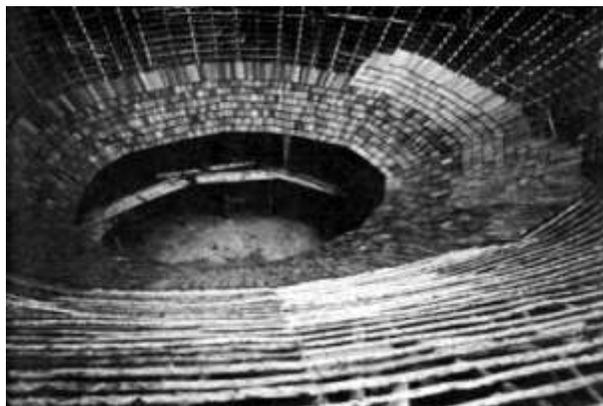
Vista da cobertura da pousada em construção, Severiano Porto, 1979. Fonte: Revista Projeto nº49, mar 1983, p. 49.
